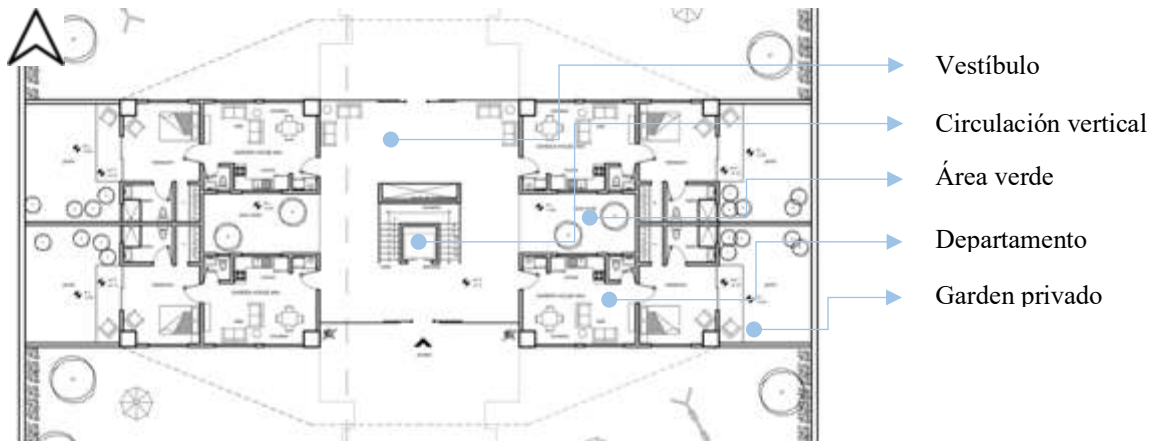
Planta baja, torre central y norte. Fuente: Elaboración propia.
